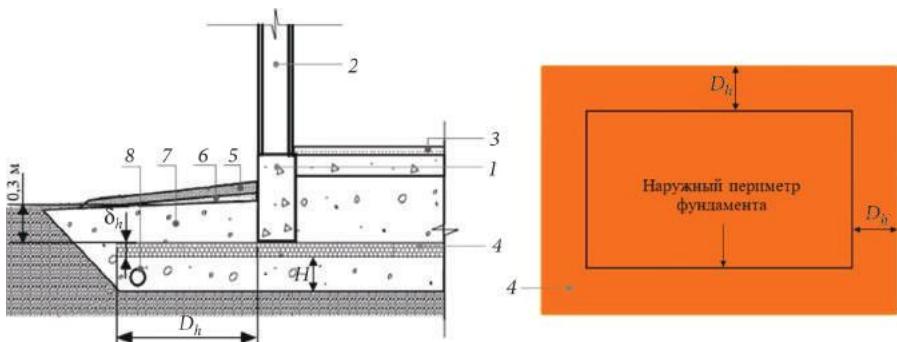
Схема укладки теплоизоляции в фундаментах неотапливаемых зданий: 1 — фундамент; 2 — стена здания; 3 — пол здания; 4 — горизонтальная теплоизоляция (XPS плиты); 5 — асфальтовая или бетонная отмостка; 6 — песчаная подготовка под отмостку; 7 — непучинистый грунт; 8 — дренаж
